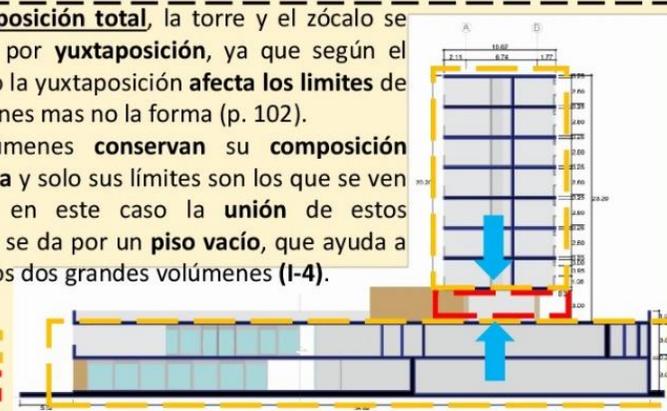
Corte A-A' escala: 1/500 Fuente: propia
